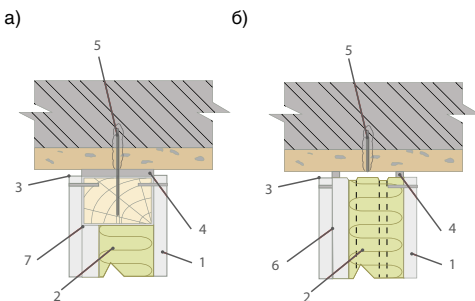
Примыкание перегородок к верхнему перекрытию:
